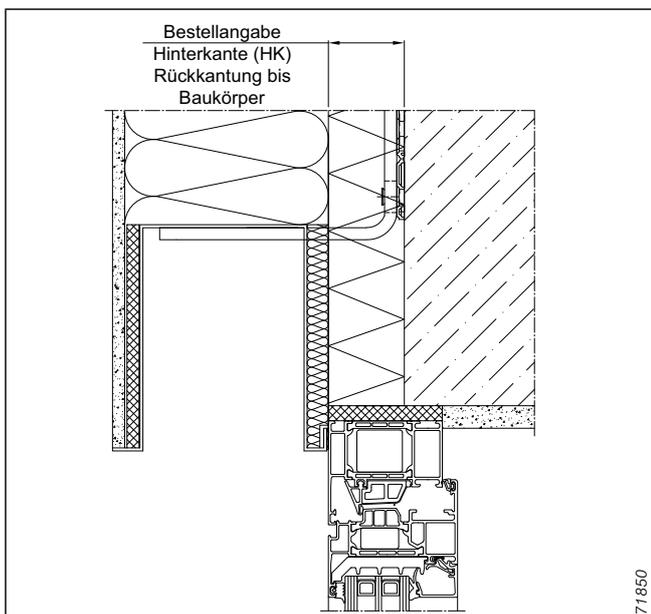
Hinterkante Rückkantung bis Baukörper für Bügellänge
